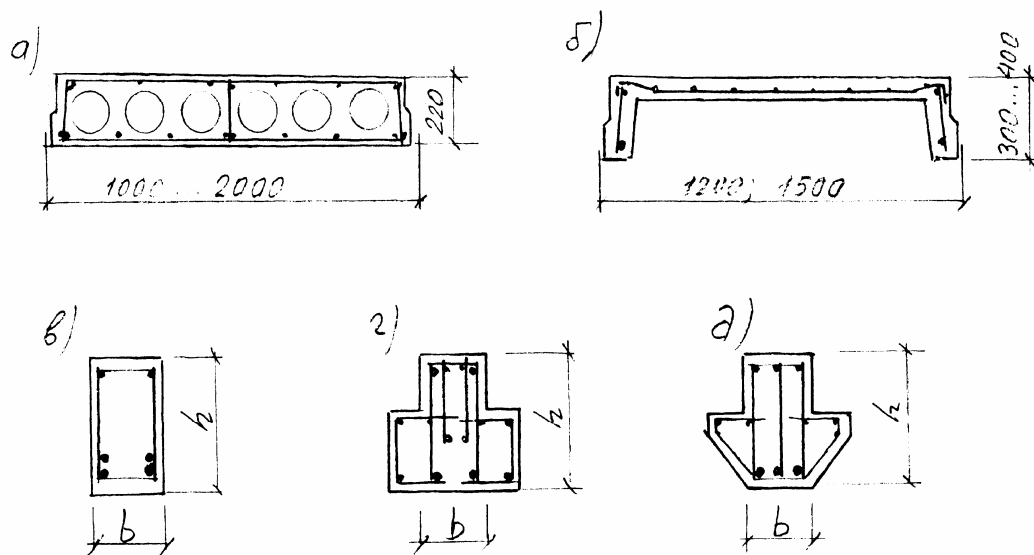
Типи панелей і ригелів збірного перекриття:
